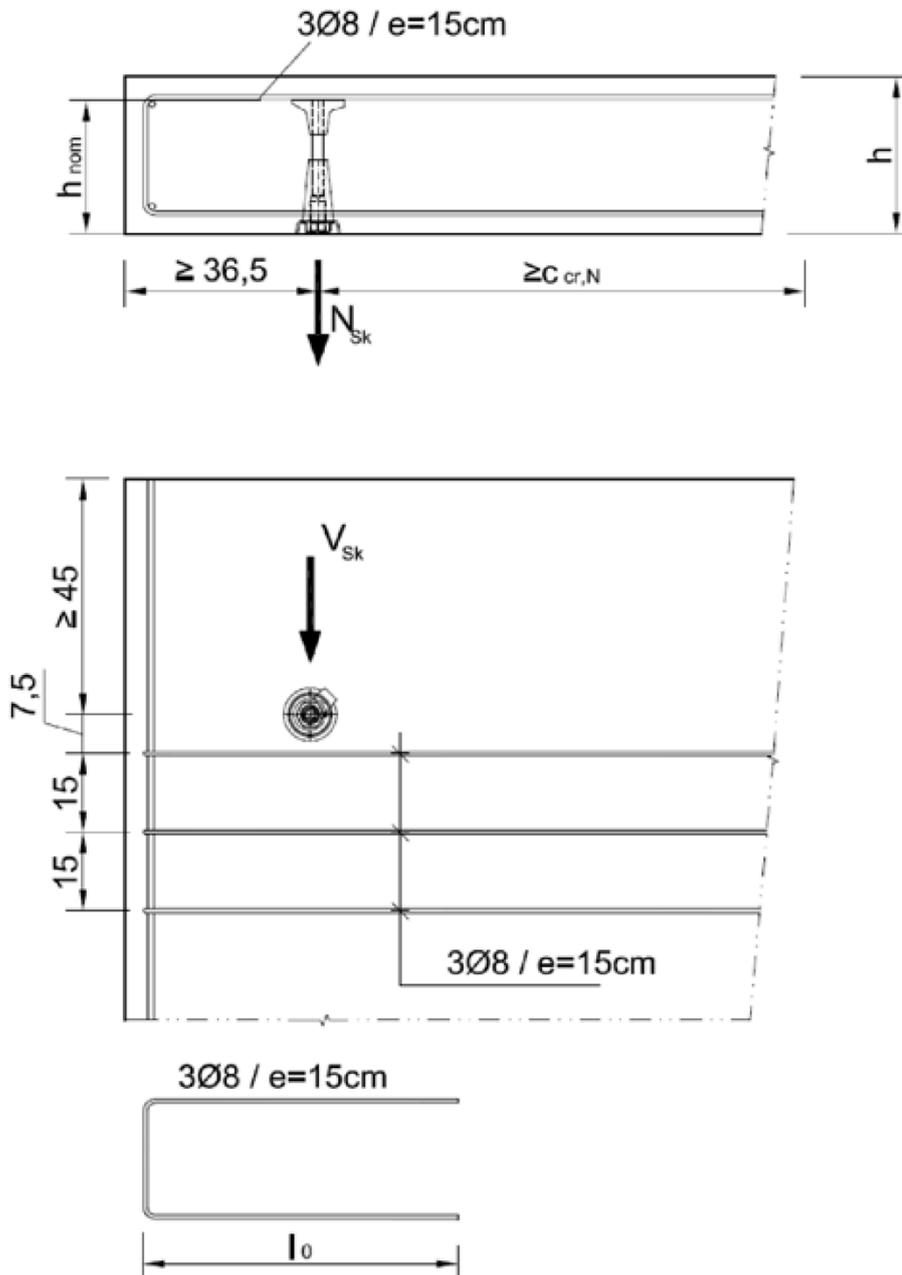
Randeffassbewehrung unterhalb des Konus (entsprechend Querkraftfrichtung) 3 Ø8mm mit $e = 15$ cm, die mit der Wandbewehrung voll zu übergreifen sind.
